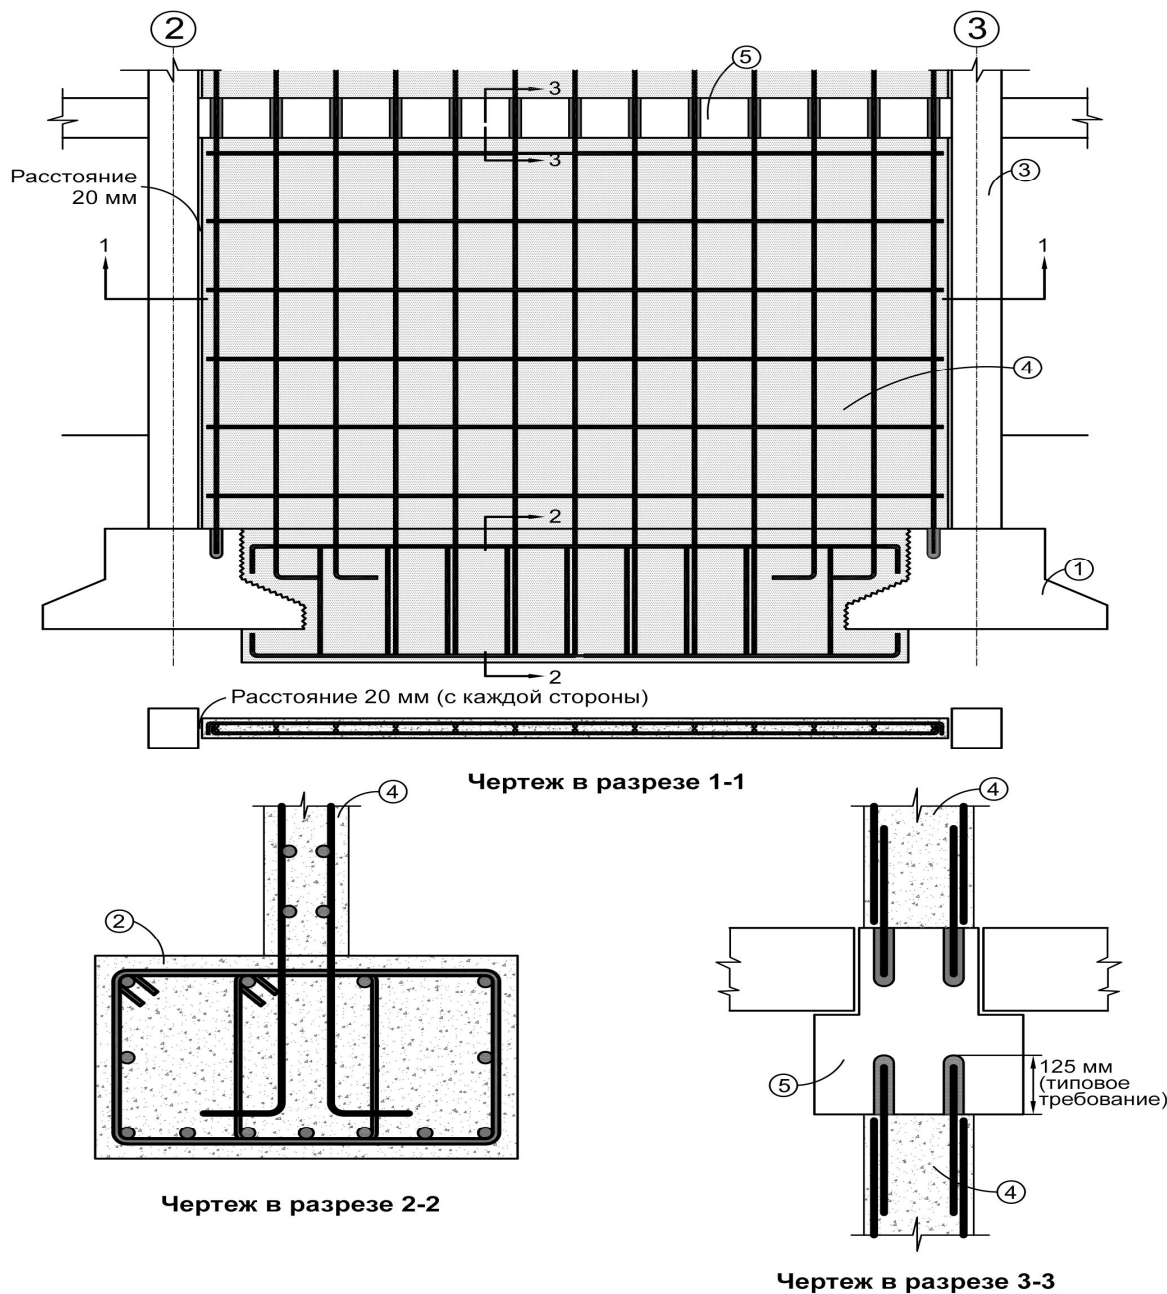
Схема усиления каркаса железобетонными стеновыми диафрагмами жесткости: 1 – фундамент существующей колонны; 2 – новый фундамент для железобетонной стеновой диафрагмы жесткости; 3 – существующая железобетонная колонна; 4 – новая железобетонная стеновая диафрагма жесткости; 5 – существующая железобетонная балка
